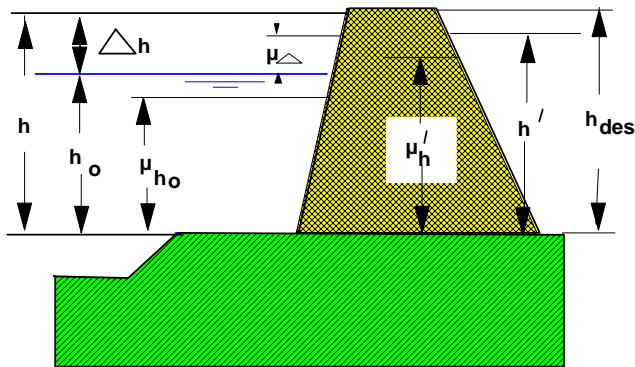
Definitionen für die Größen einer stochastischen Deichbemessung
